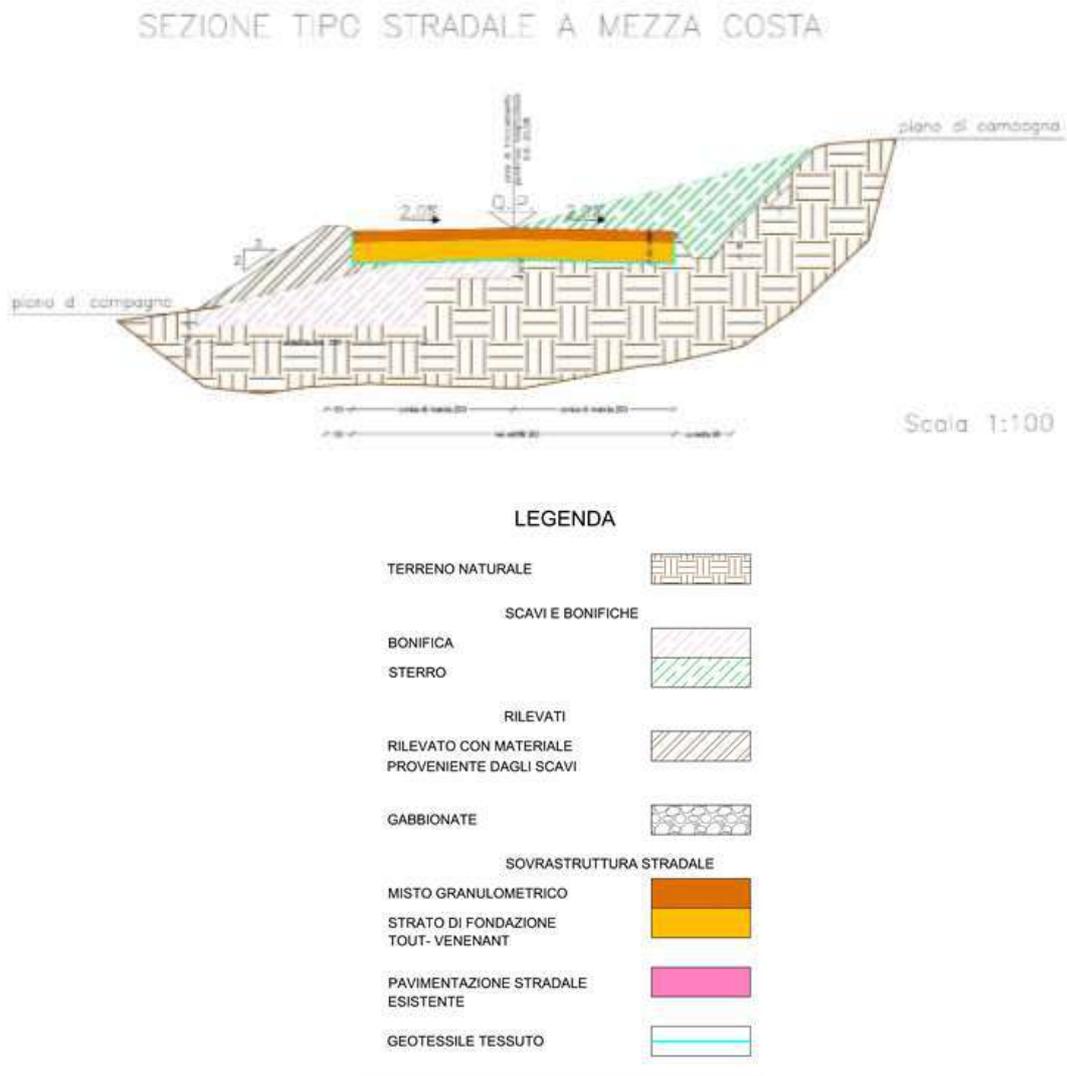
Sezione tipo strada di cantiere di nuova costruzione
